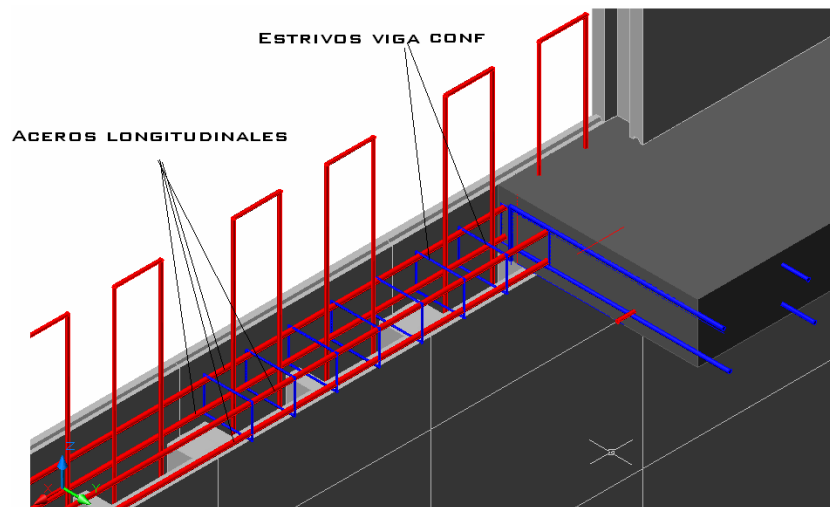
REFUERZO VIGA CONFINAMIENTO DE ENTREPISO GRUPO B (CUATRO BARRAS 3/8")
